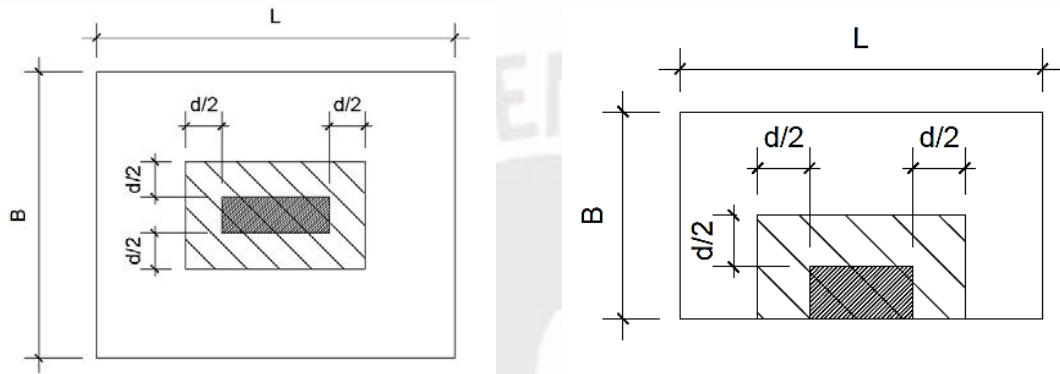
Esquema típico de sección crítica en zapatas aisladas y laterales – diseño por punzonamiento
